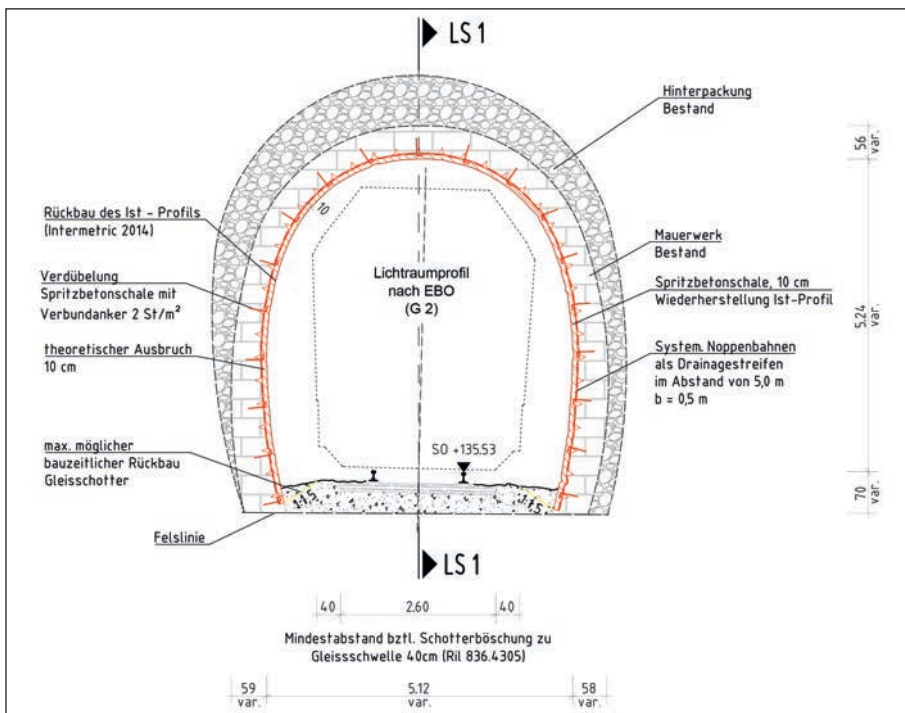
Tunnelquerschnitt mit geplanten Maßnahmen
